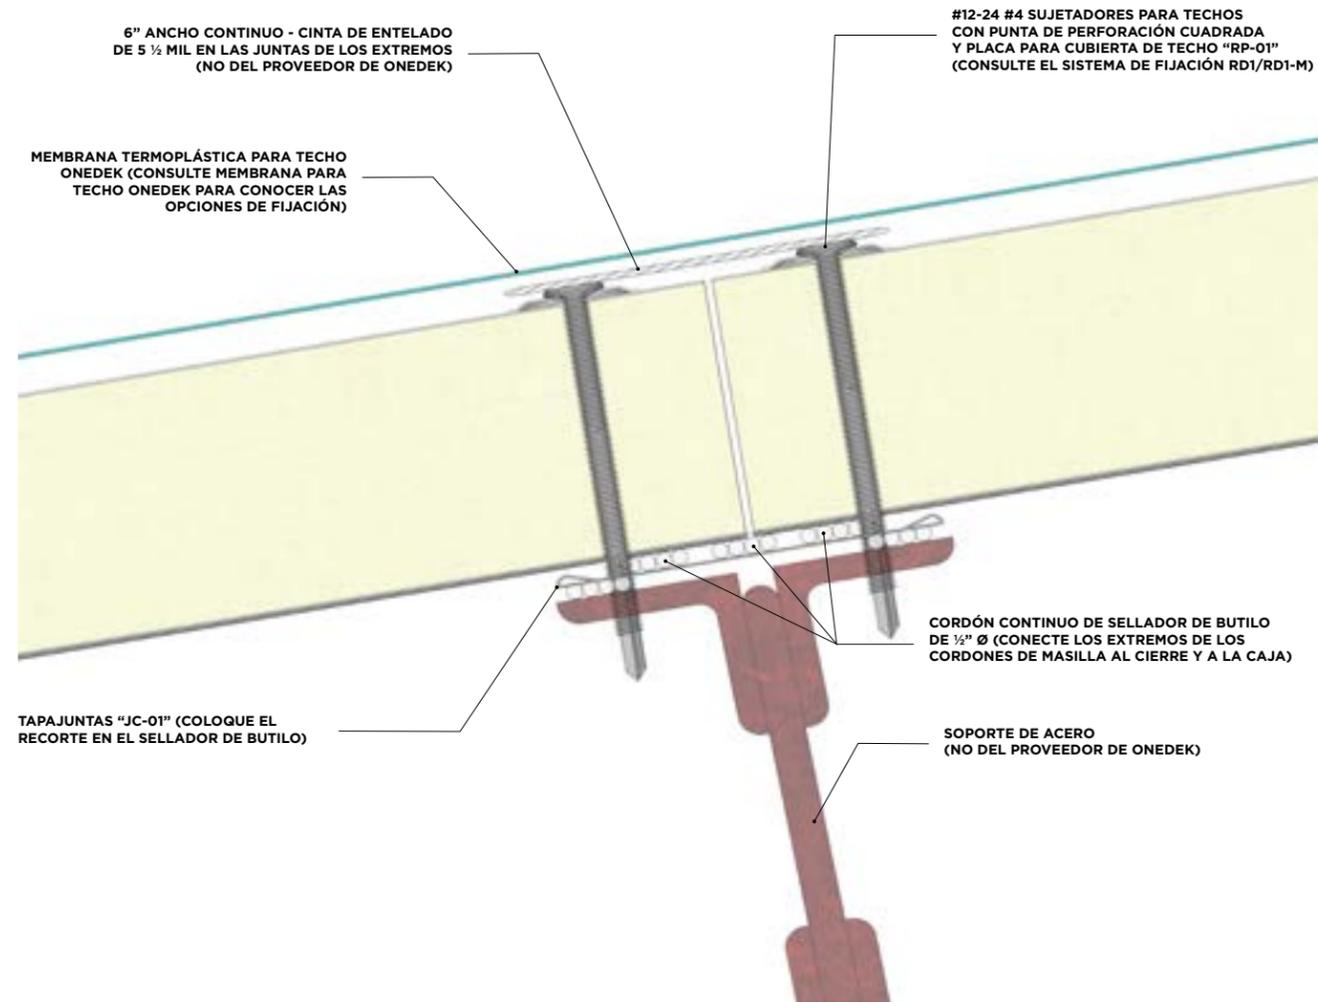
DETALLE DE VIGA CON CUBREJUNTAS (VISTA DE LA SECCIÓN)
